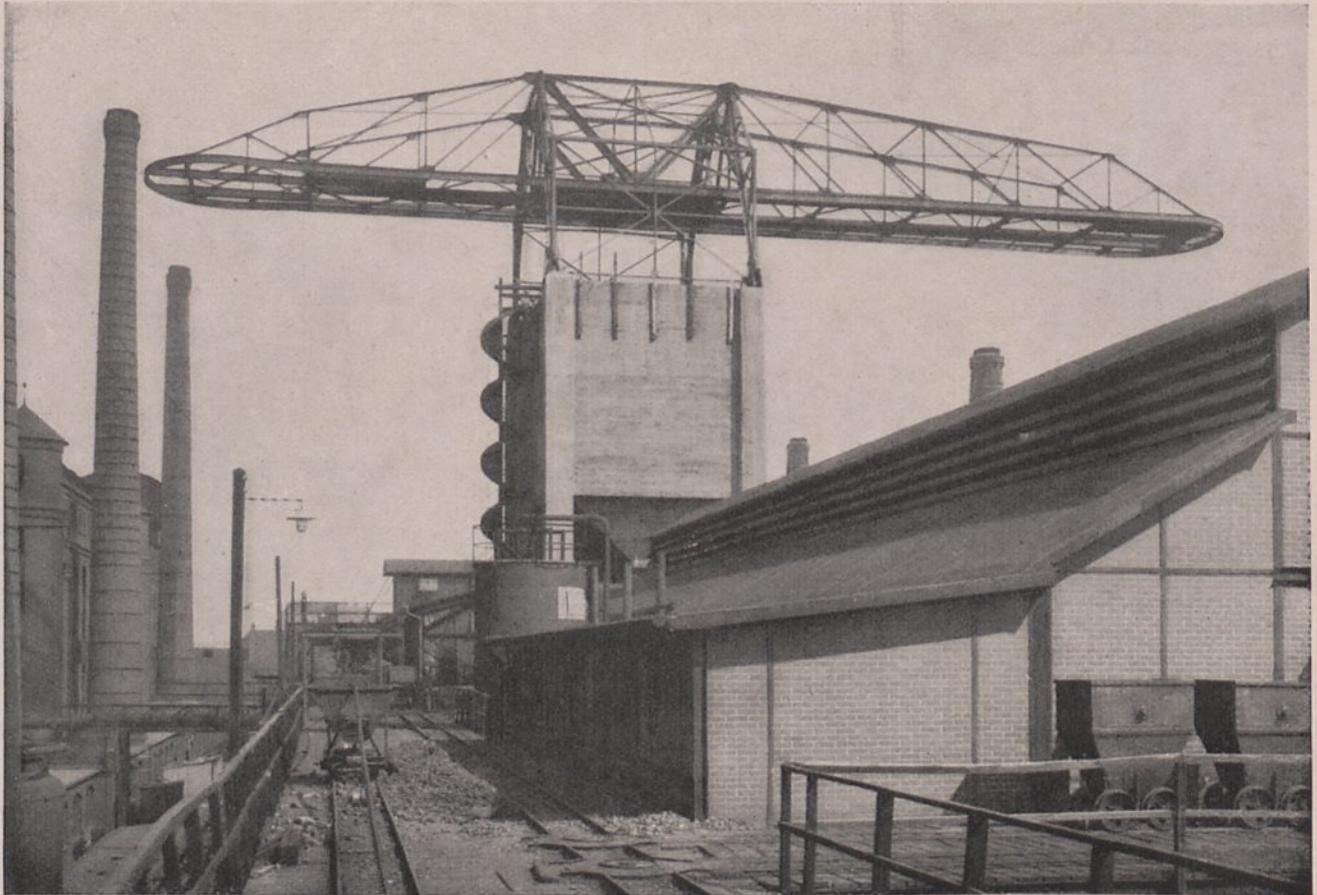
Kohlenhochbehälter mit Ladebrücke, Berliner Städt. Gasanstalt, Danziger Straße,
